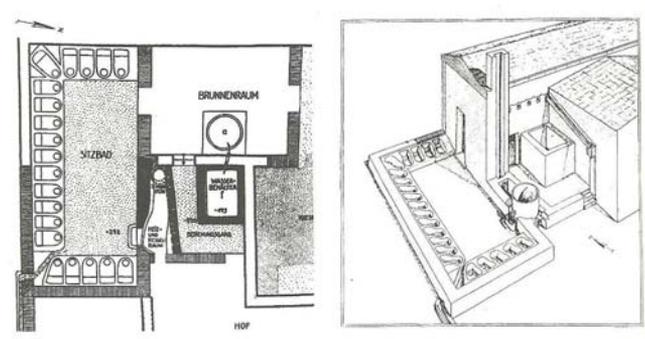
Olympia. „Jüngeres Sitzbad“ (Bau III) links: Grundriss rechts: Rekonstruktion
